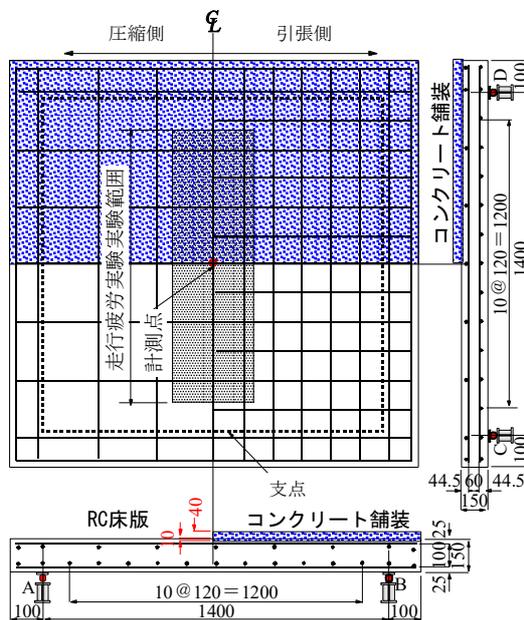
RC床版・舗装供試体の寸法および鉄筋配置
